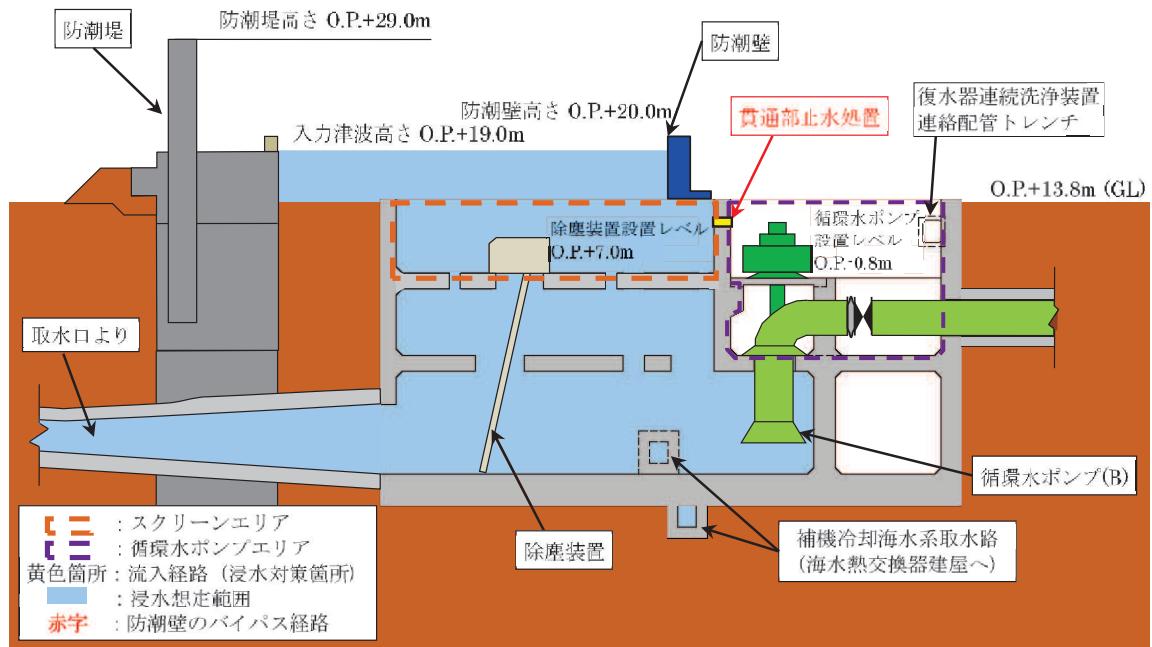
第3号機 海水ポンプ室 浸水対策配置図（A-A断面図）
